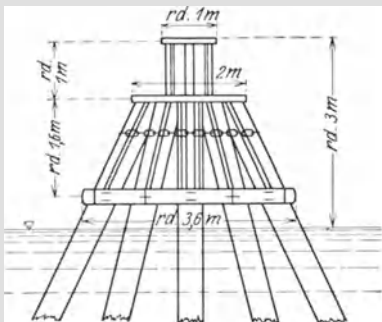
Kieler Pfahlbündel. Maßstab 1 : 135.
